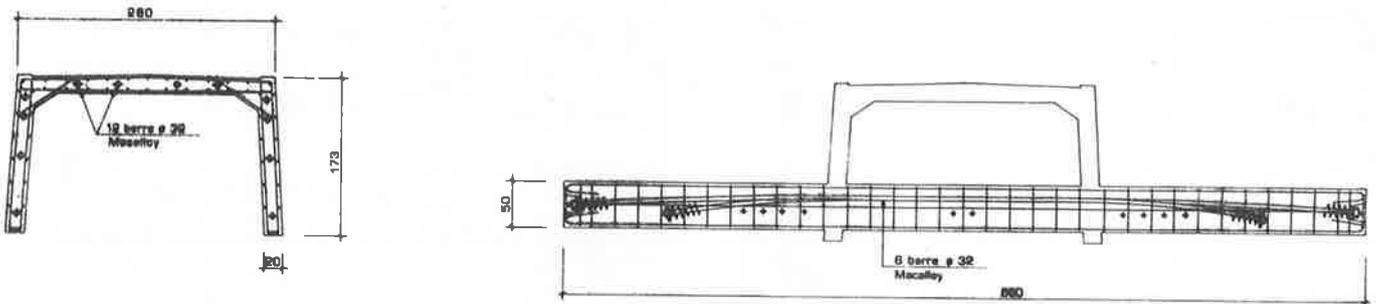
Pontile SARAS - Sezione e armatura della travata continua precompressa prodotta per estrusione
